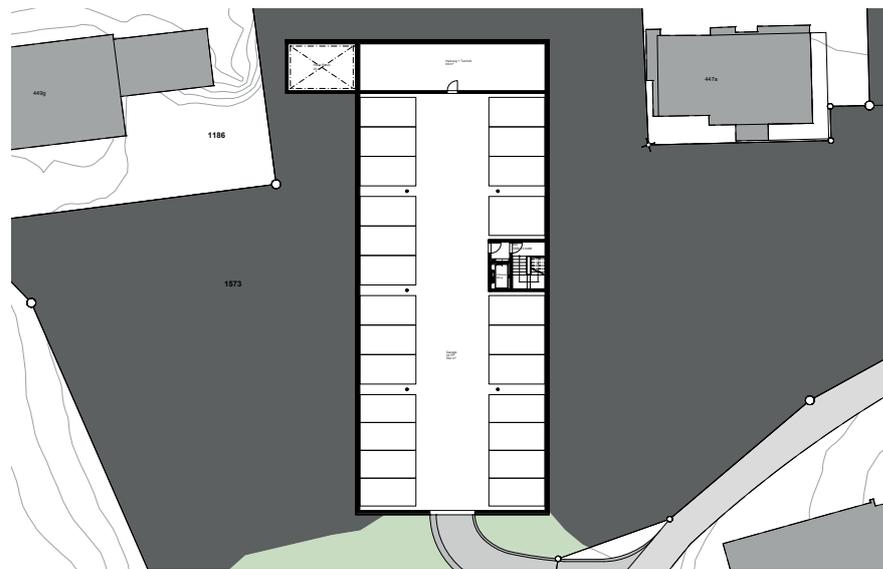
Einstellhalle im Untergeschoss mit 24 Fahrzeugabstellplätzen und Technikraum zvg baulink AG
